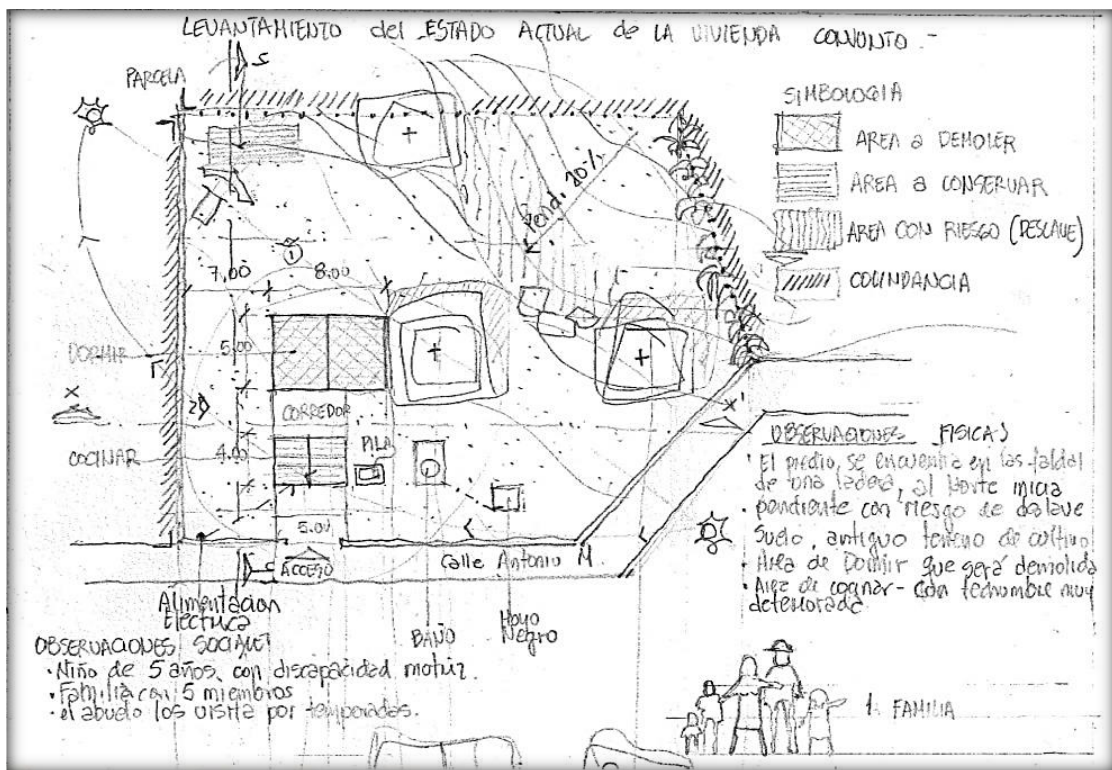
Croquis del levantamiento. Elaboración Propia.
